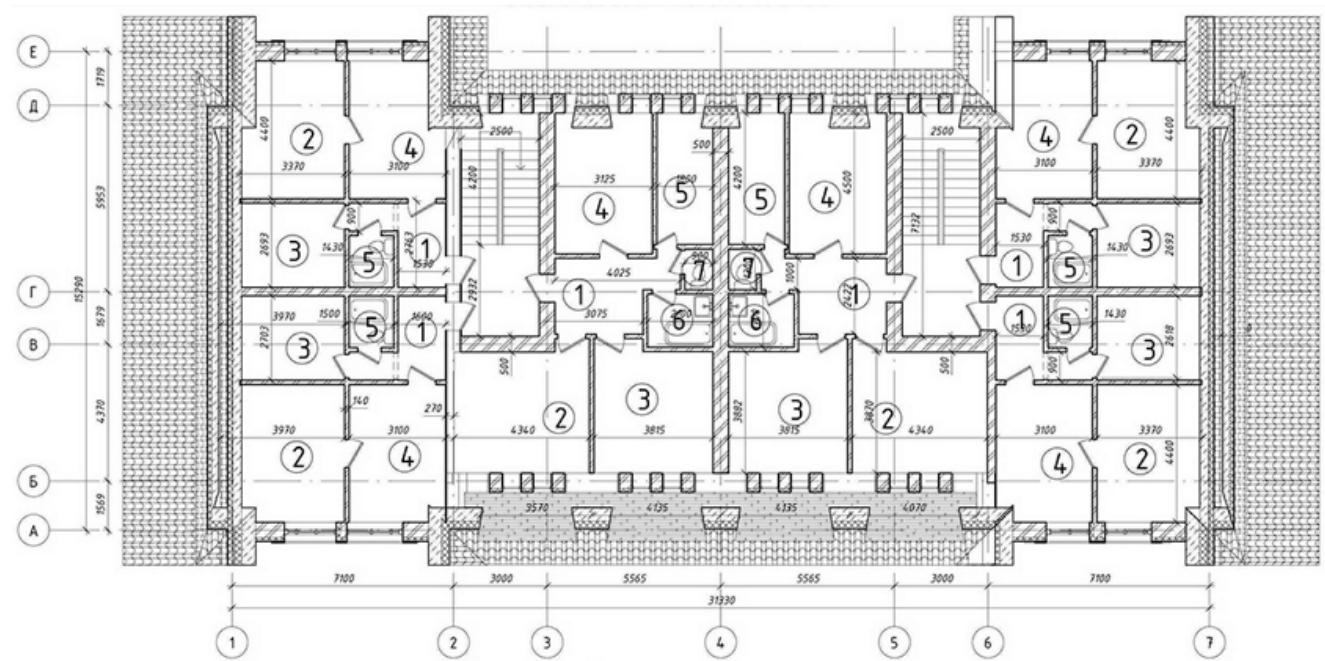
План 3-го этажа на отметке + 6,400 М 1:100
